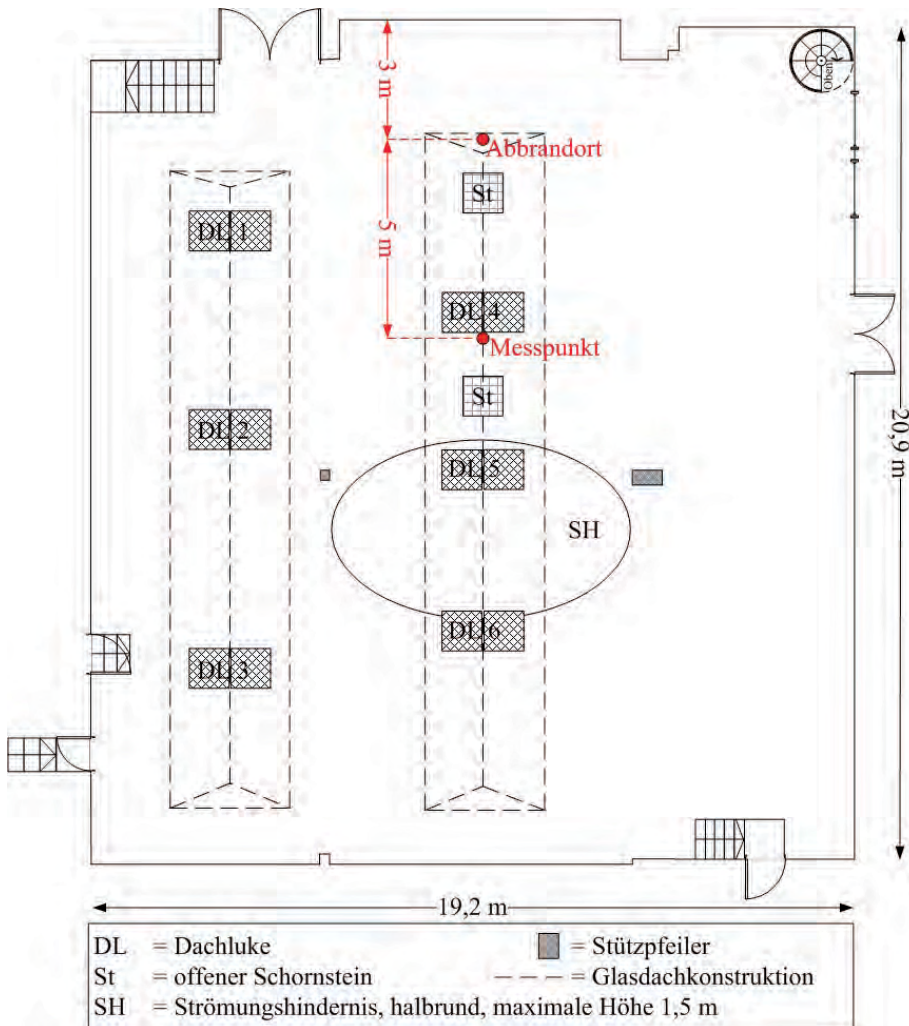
Grundriss des ehem. Kesselhauses der Werkshalle 21 in Wildau, Deutschland
